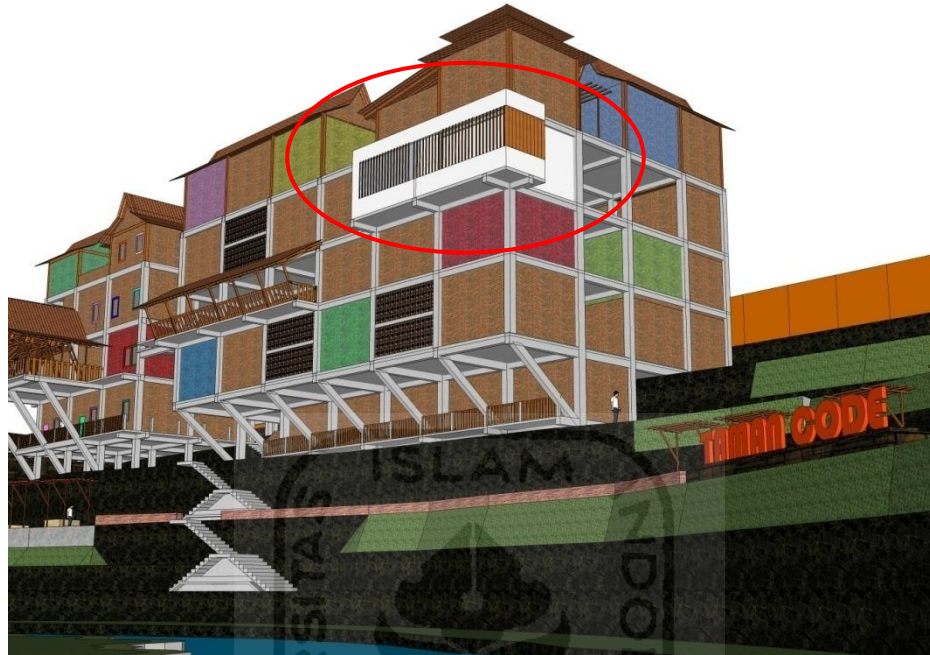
Letak food court yang di tandai dengan warna biru pada denah dan lingkaran merah pada 3d.
